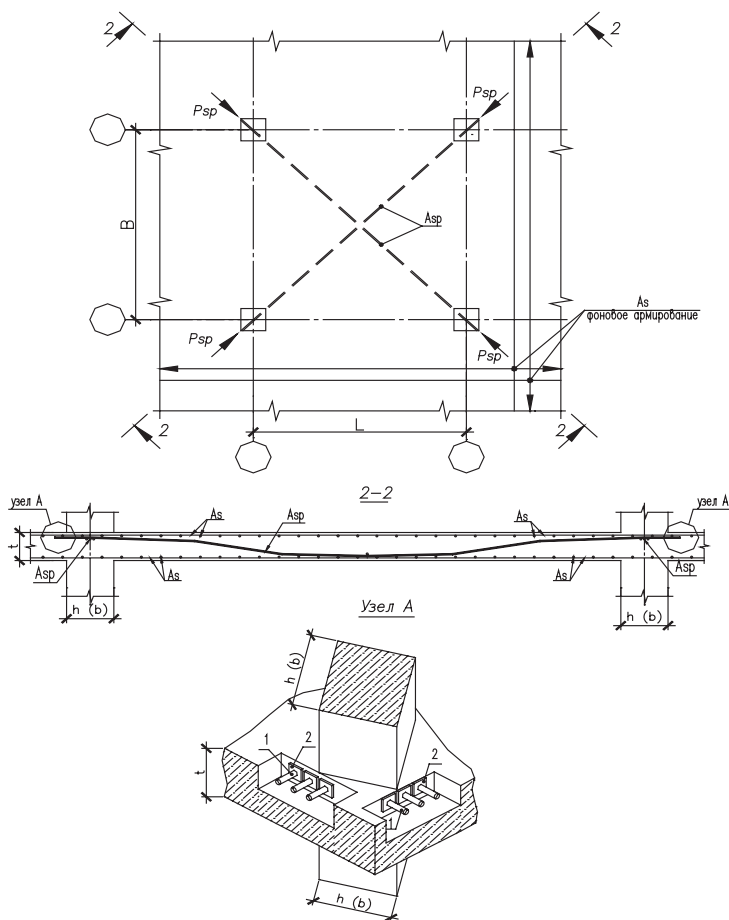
Армирование предварительно напряженной арматурой отдельной ячейки перекрытия. Узел А: 1 — опорная пластина «якорь»; 2 — выпуски канатной арматуры
